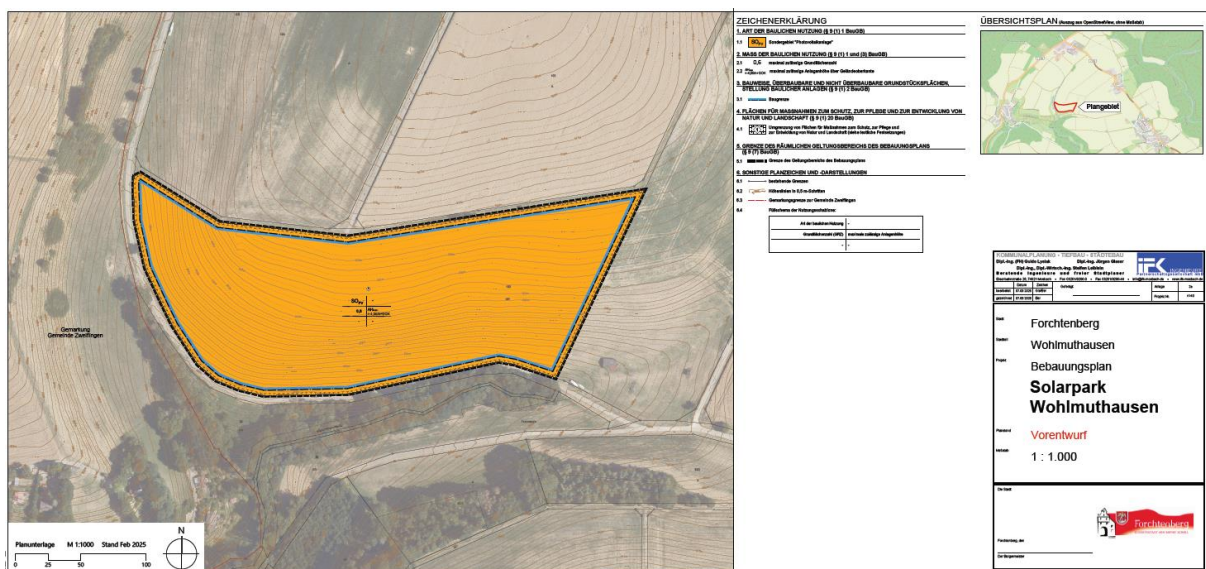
Vorentwurf Bebauungsplan „Solarpark Wohlmuthausen“. Quelle: IFK INGENIEURE
